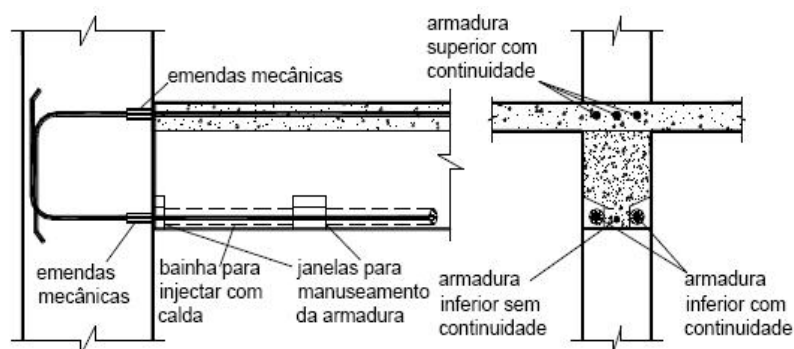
Ligação viga – pilar em vigas rectangulares com betonagem complementar (extraída de [7])
